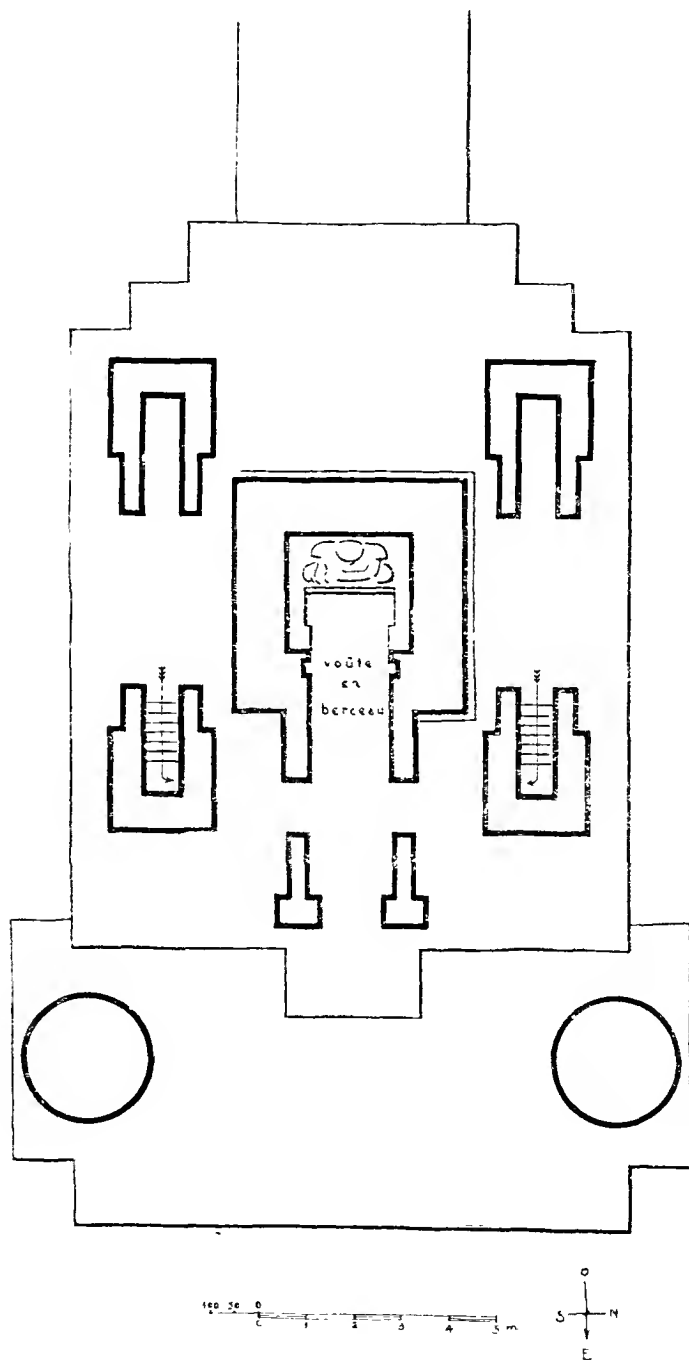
C'ING MÃI. Wât Cêt Yôt. Plan au niveau de la terrasse.
